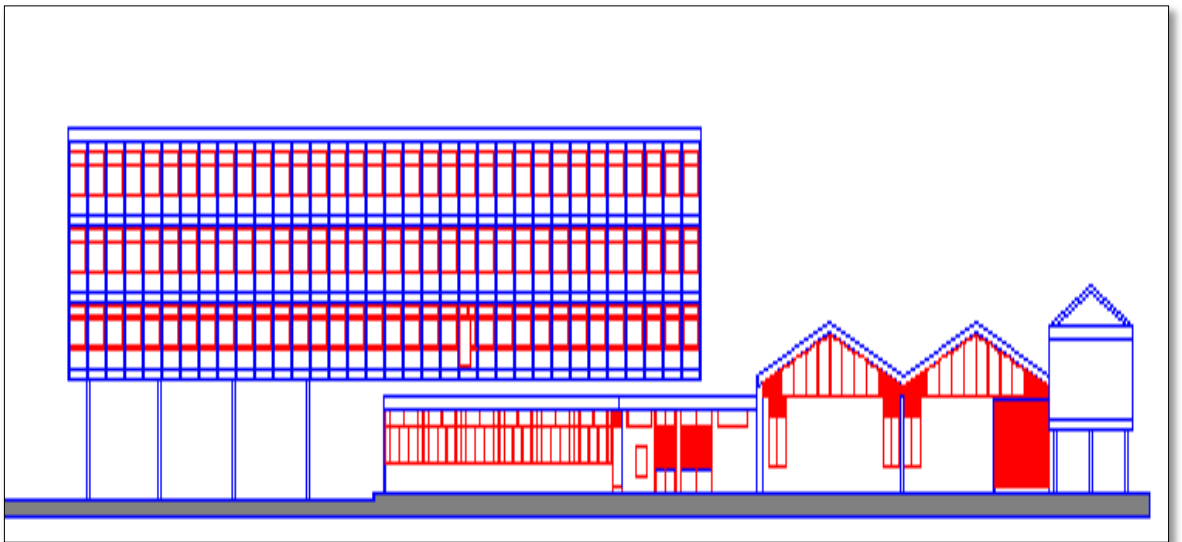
corte transversal de las edificaciones bautizadas de la 4.1, 4.2 y 4.3 de izquierda a derecha respectivamente.
